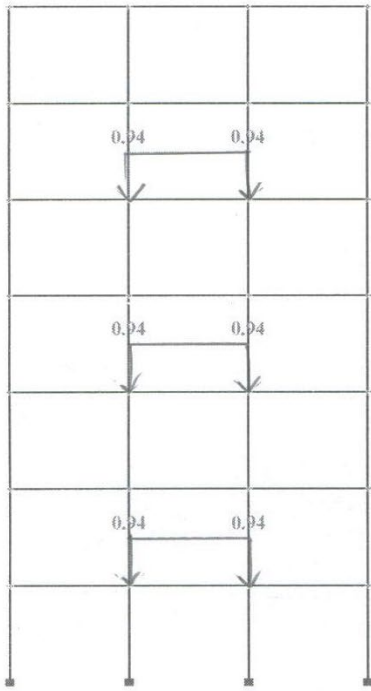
Схема завантаження рами у середньому прольоті по чотним поверхам навантаження від людей та устаткування.
